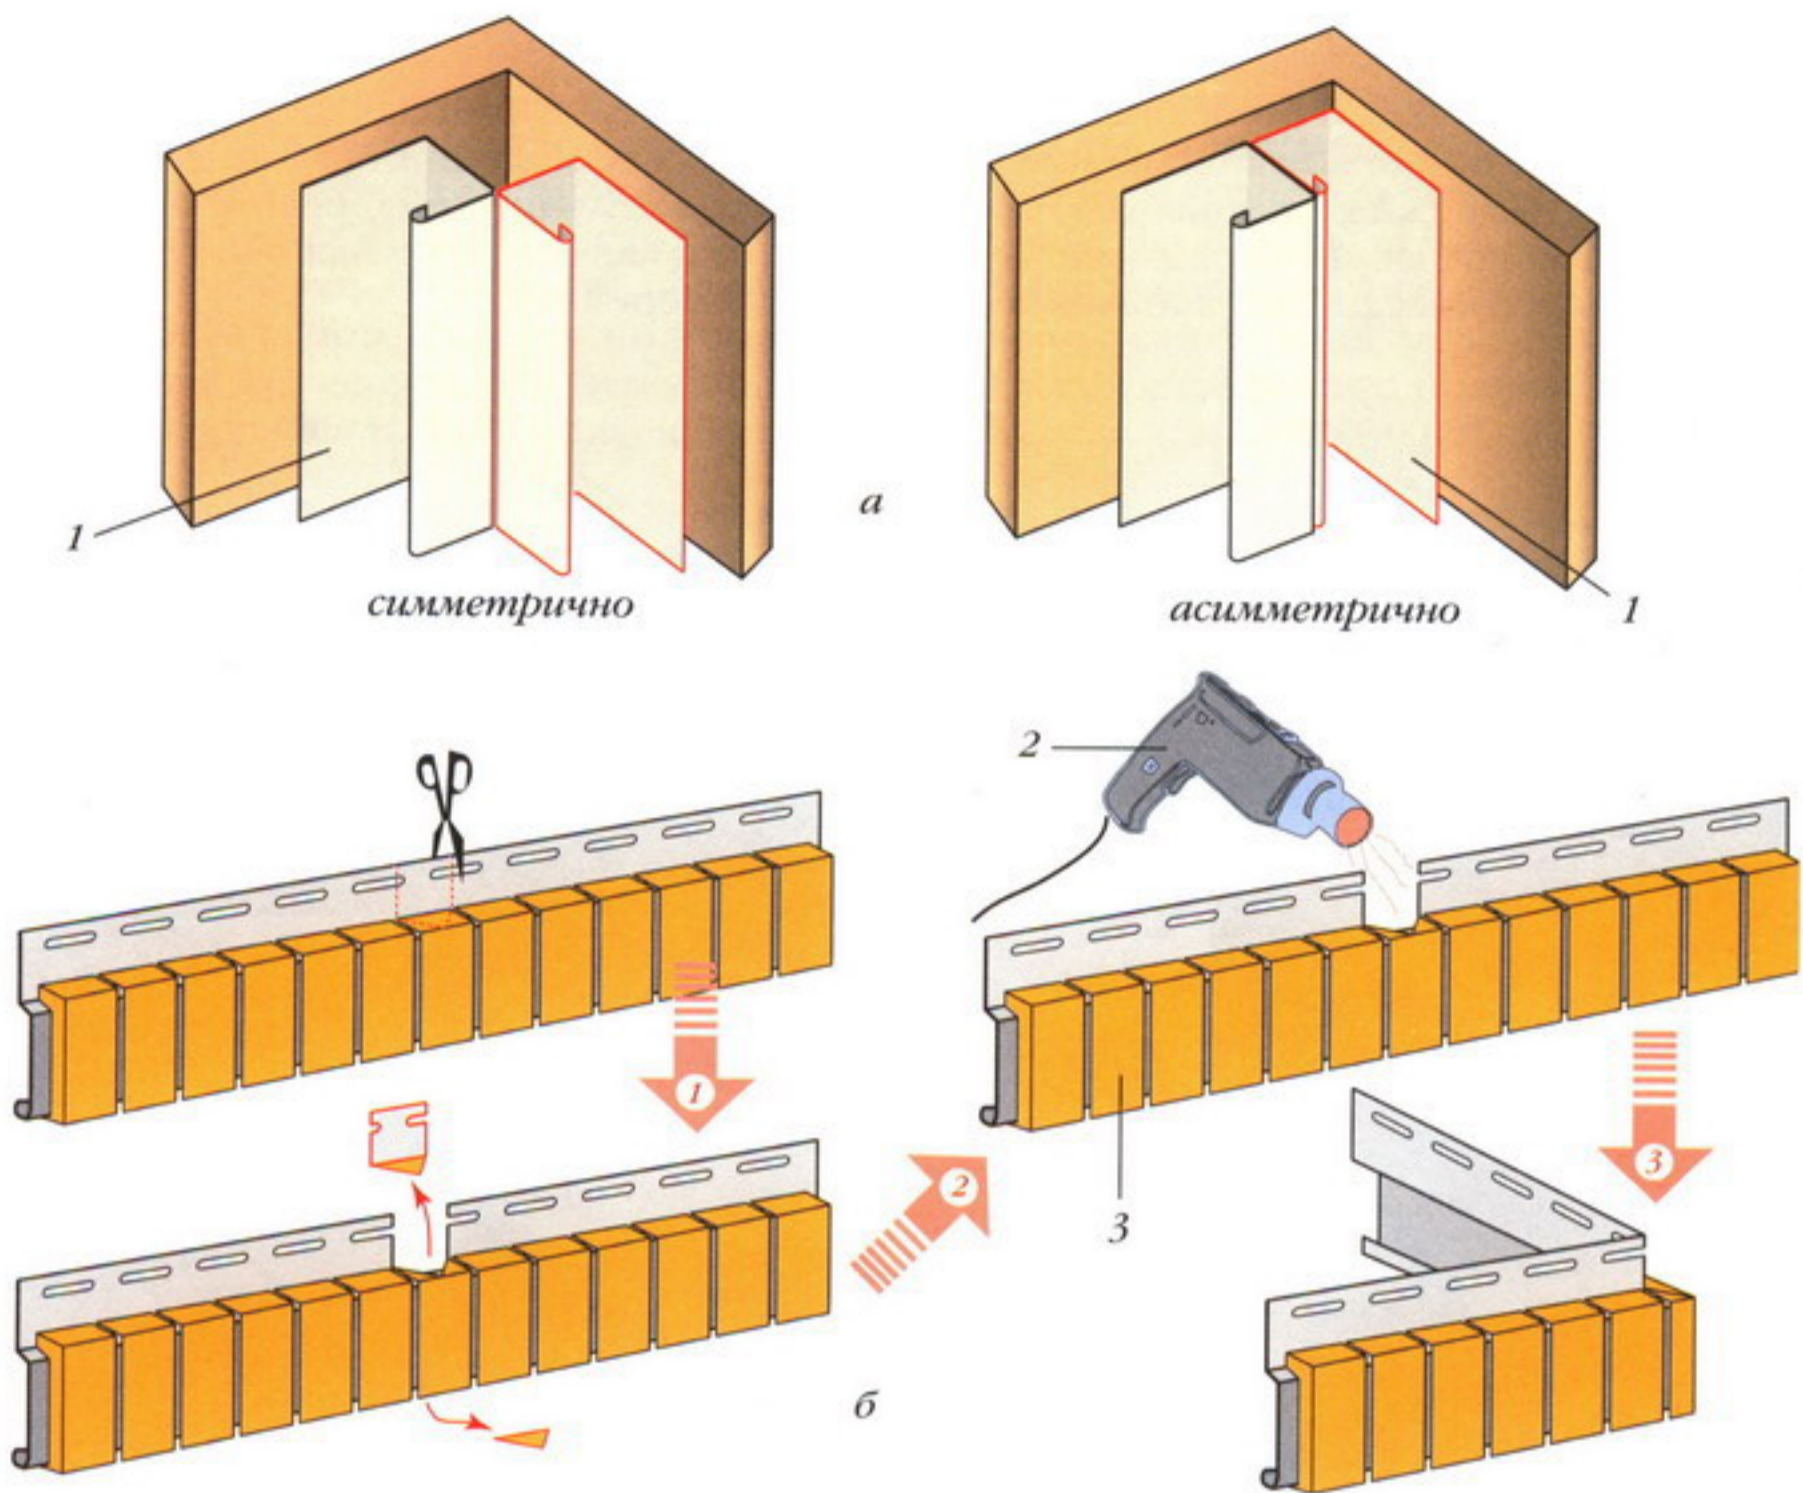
Установка внутренних углов и карнизов: а — установка J-профилей; б — гнутье карнизов; 1 — J-профили; 2 — строительный фен; 3 — виниловый карниз
